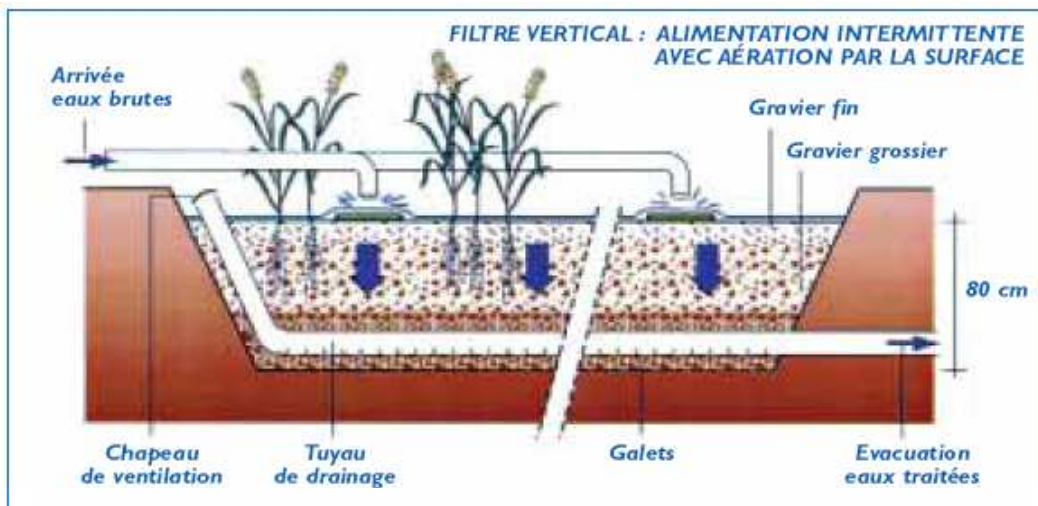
Coupe transversale d'un filtre planté de roseaux à écoulement vertical
